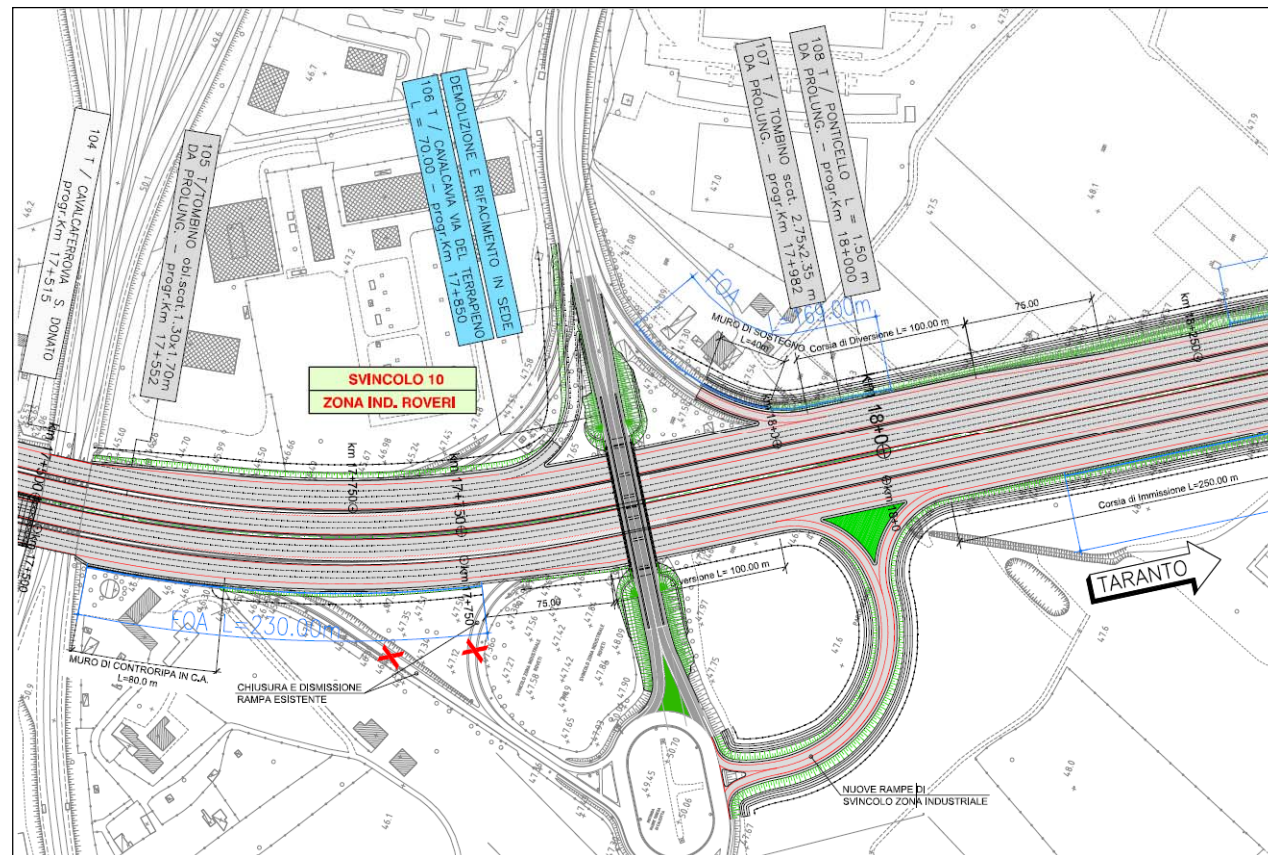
Dettaglio planimetrico dello Svincolo 10 – Roveri
